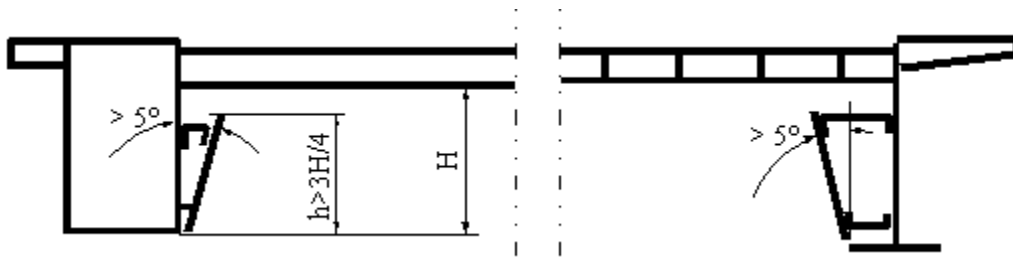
Querschnitt einer Brücke (schematisch) mit Schrägeinbauten
